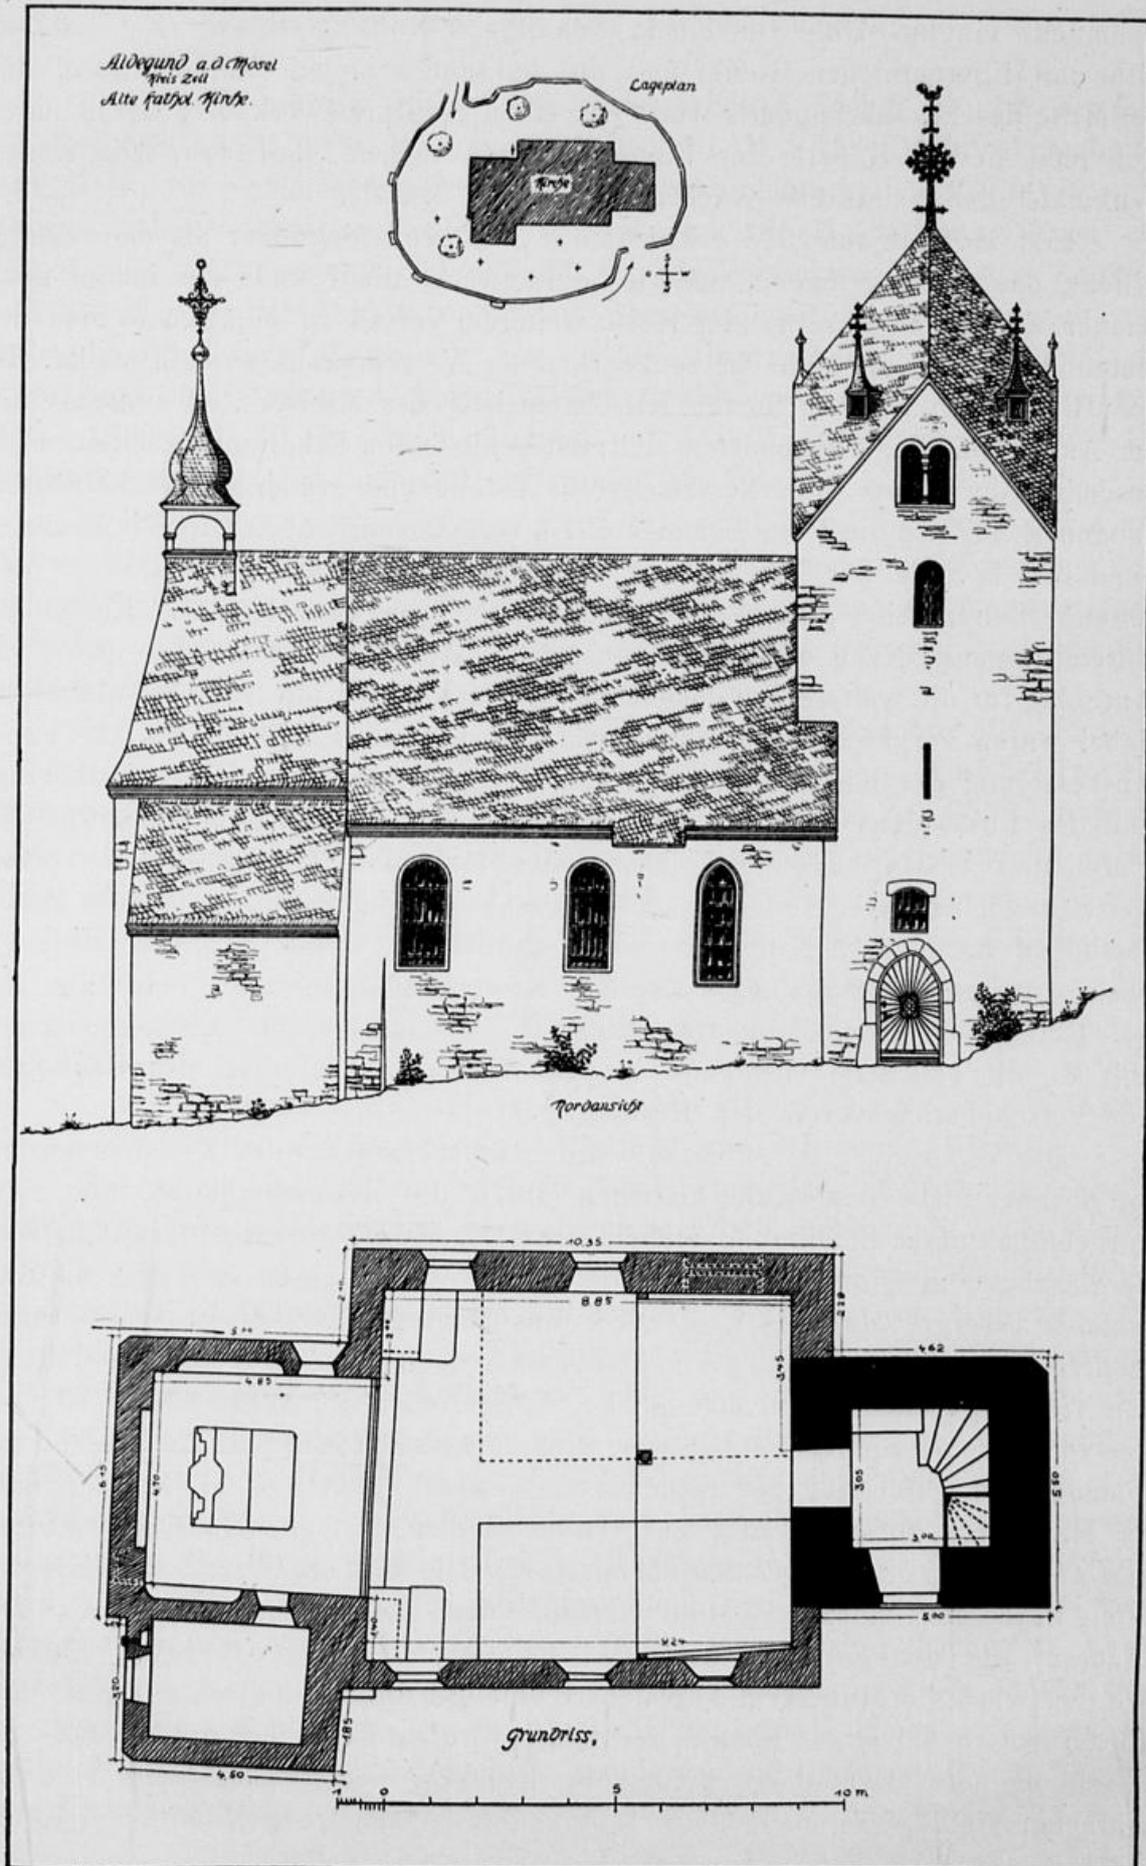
Aldegund, alte Pfarrkirche. Grundriss, Seitenansicht u. Lageplan.
